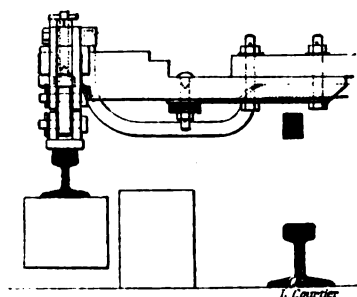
Elevated* de Chicago : coupe du rail isolé, avec vue en bout du sabot de contact.
